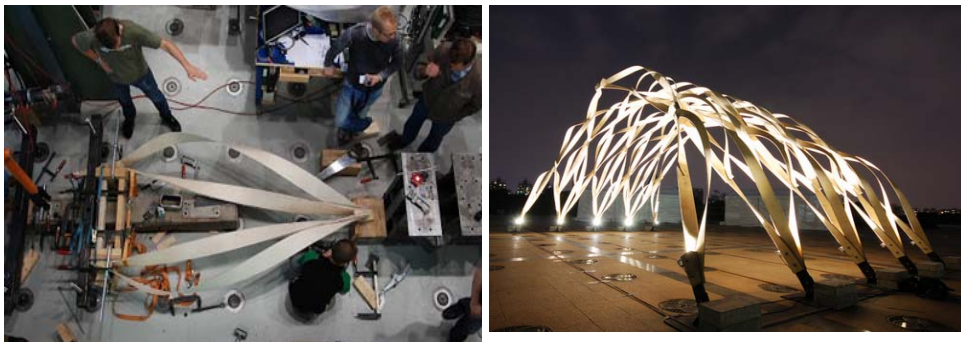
Испытание элементов конструкции «Radical wood pavilion»
